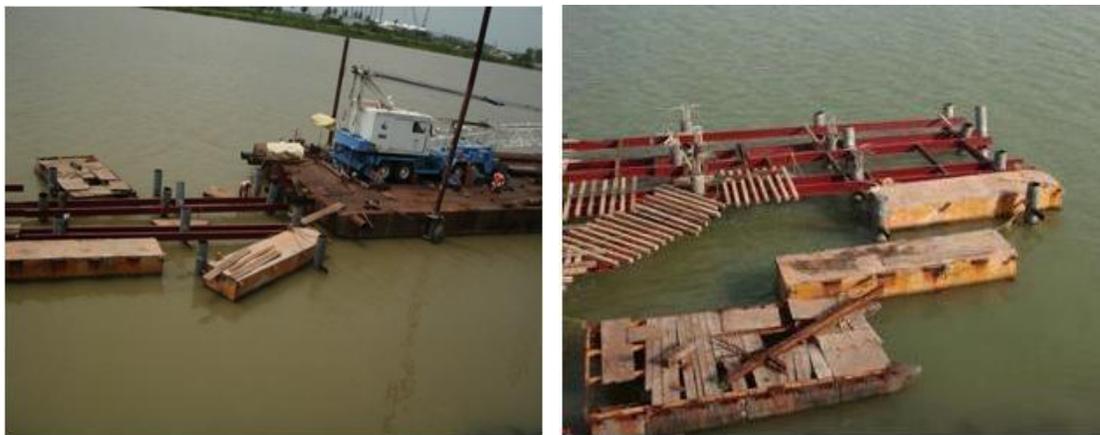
Colocación de la obra falsa, a base de viguetas IPR tipo I de 12"x6.5", y desplante de la cimbra para las superestructuras del muelle, en los ejes 6, 5 y 4 entre los ejes D a G.
